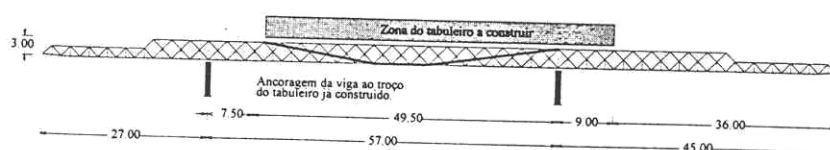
Cembre dimensionado para obras de vãos diferentes
